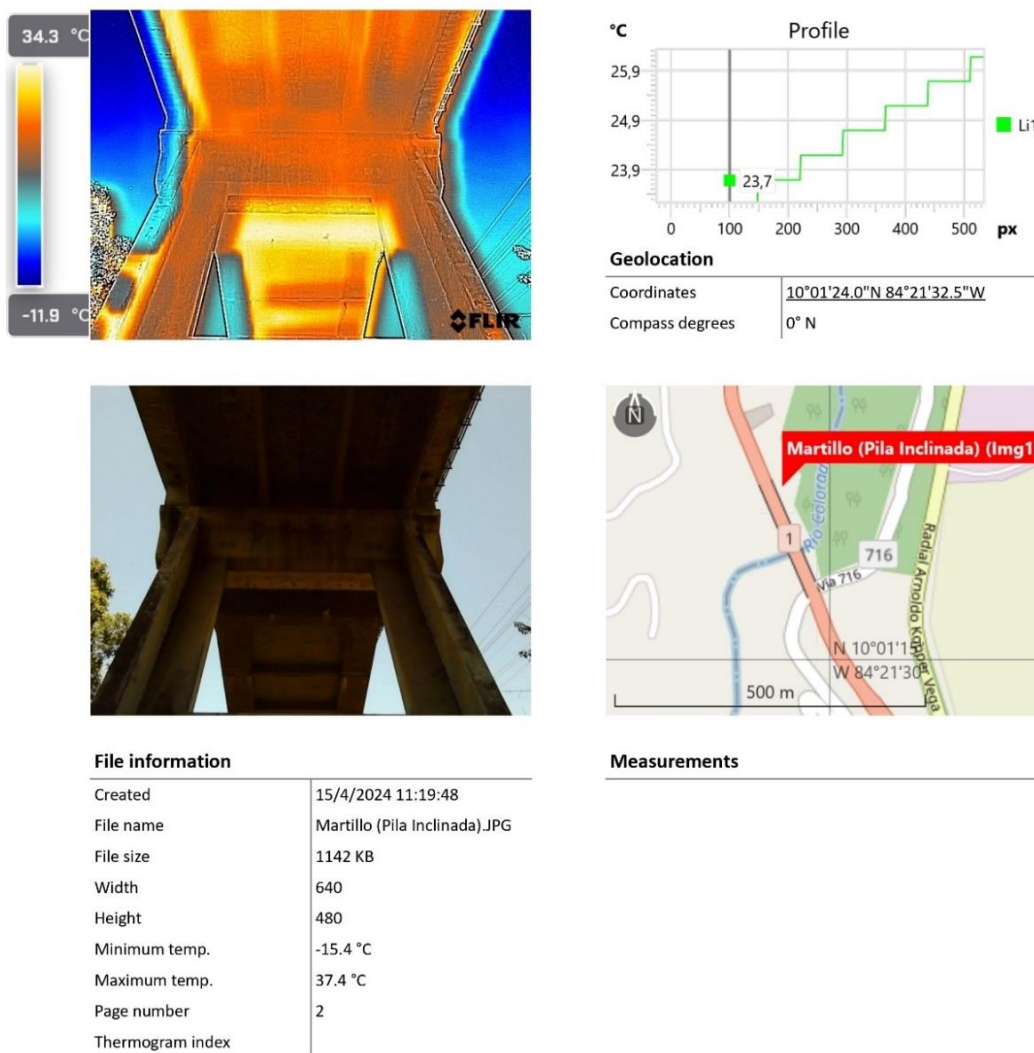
30 Reporte térmico de grietas en martillo (pila inclinada) de la sección No. 8
